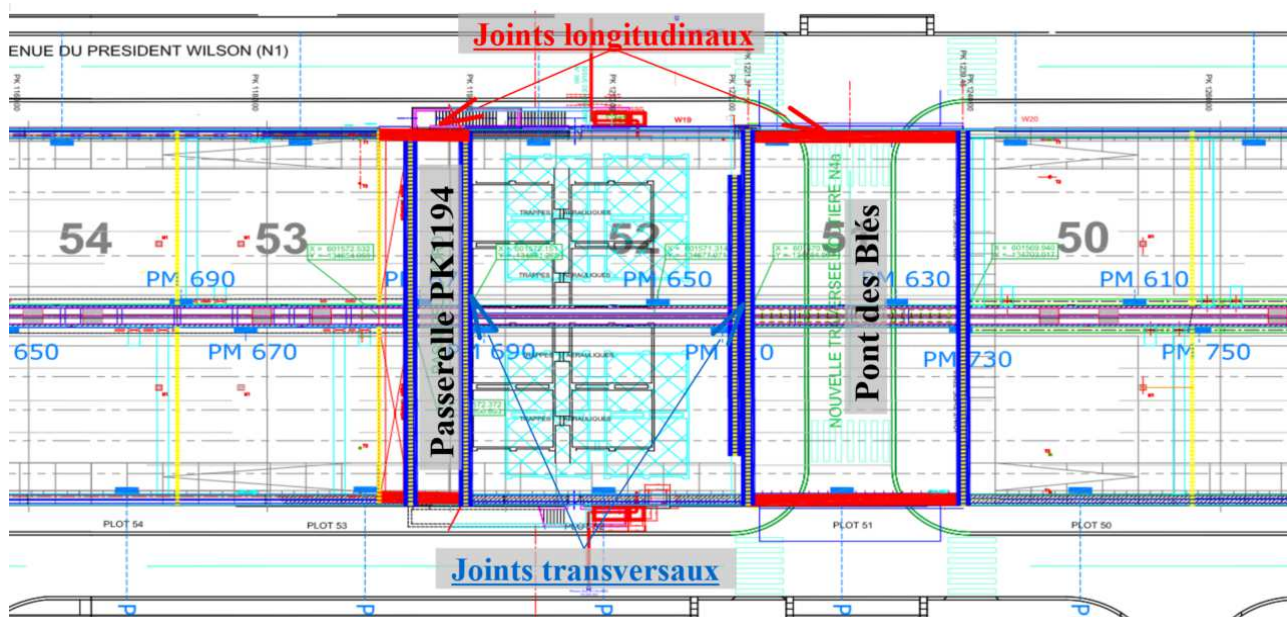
Extrait de la vue en plan des joints de chaussée de la Passerelle PK 1194 et du Pont des Blés
